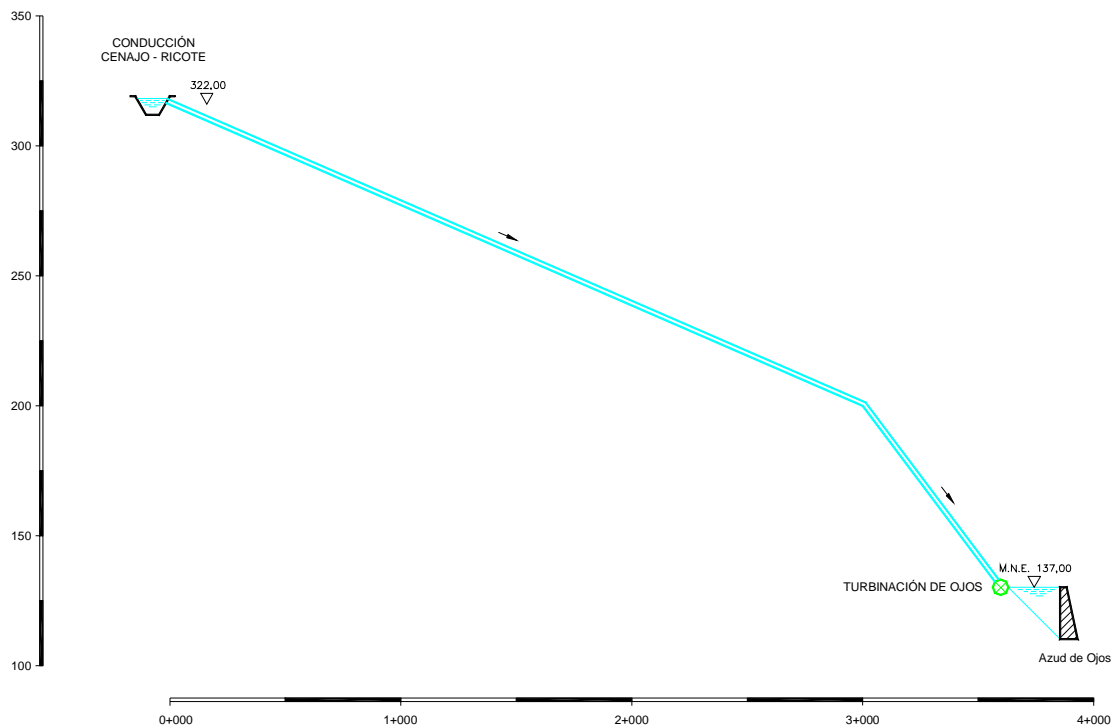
Conducción Ricote-Ojós. Esquema en alzado
